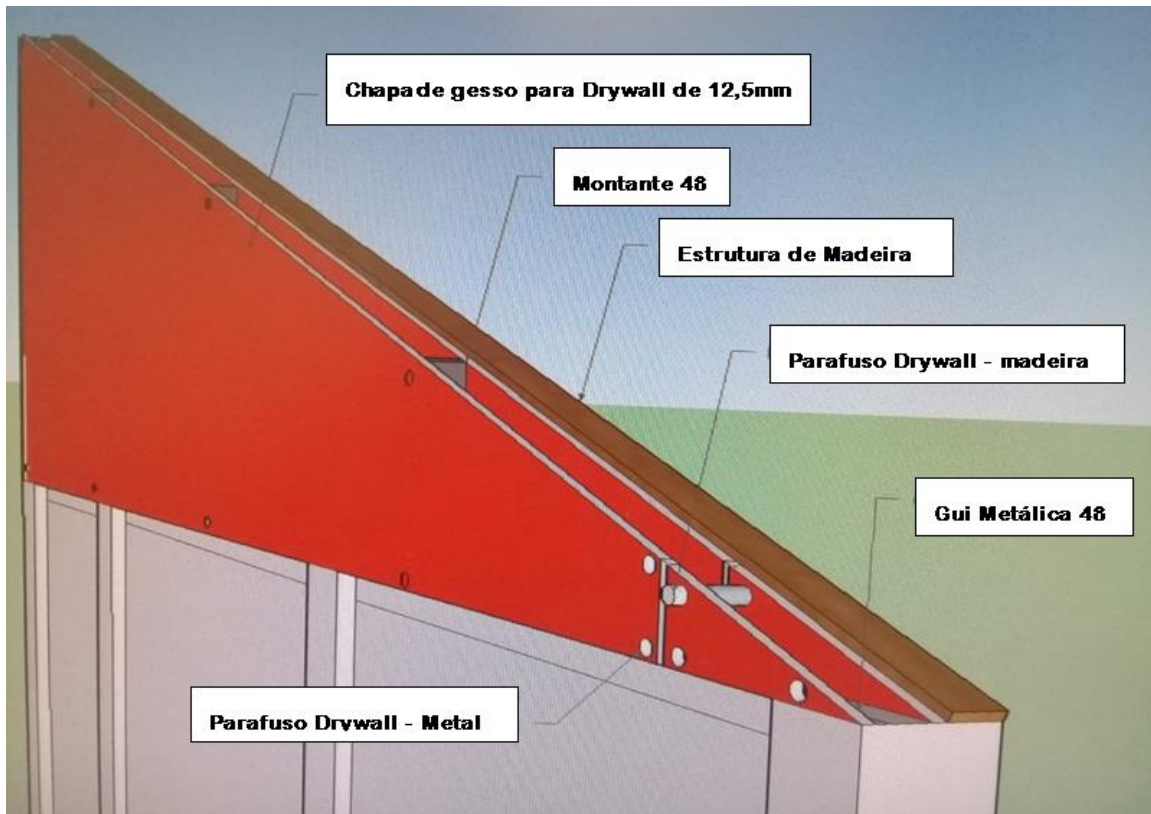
Detalhe Fixação do septo vertical na tesoura (área face do parede voltada para o ambiente adjacente à cozinha).
